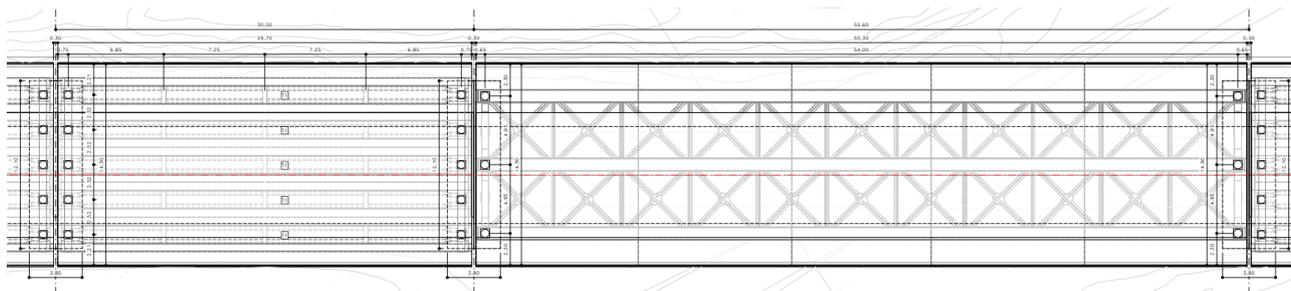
Vista in pianta degli impalcati in c.a.p. e struttura mista
